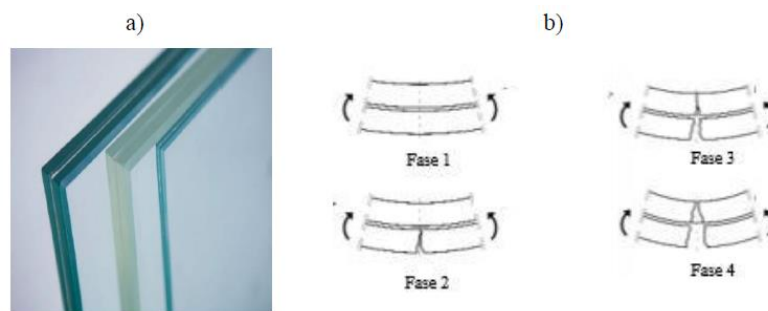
a) Exemplo de vidro laminado; b) Mecanismo de rotura do vidro laminado (adaptado Overende et al., 2010).
